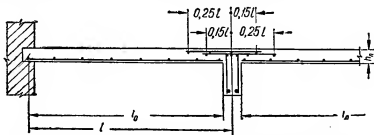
80. Армирование балочных плит над опорами двумя сварными сетками с поперечным расположением рабочих стержней.
